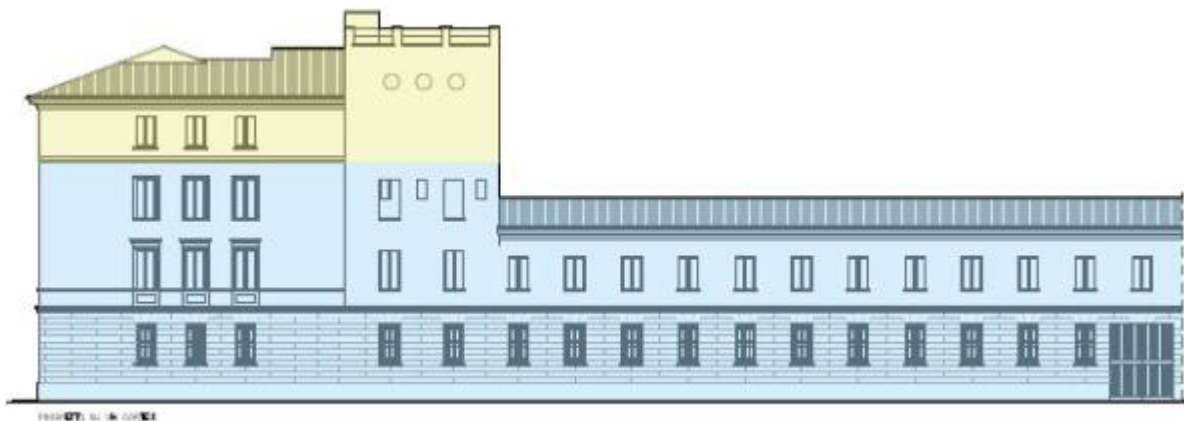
Prospetto su via Cortesi, individuazione corpo originario e successiva sopraelevazione
